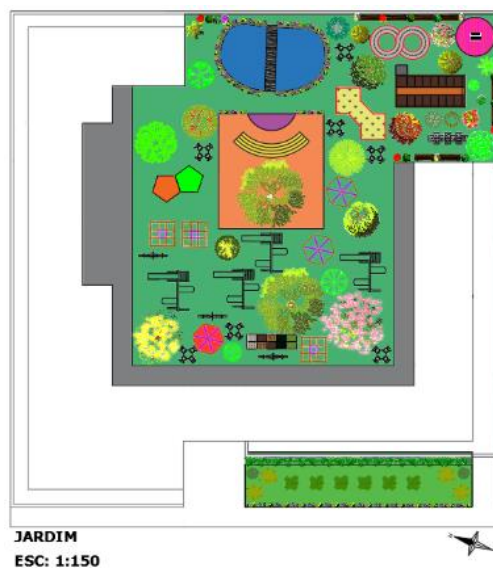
Planta do Jardim (Fonte: Produção do autor)
